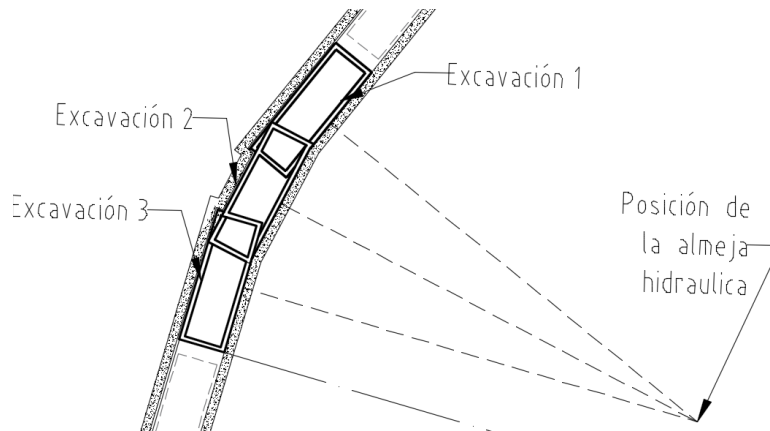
Vista en planta de los movimientos de la almeja hidráulica para excavar un panel.⁴⁷
